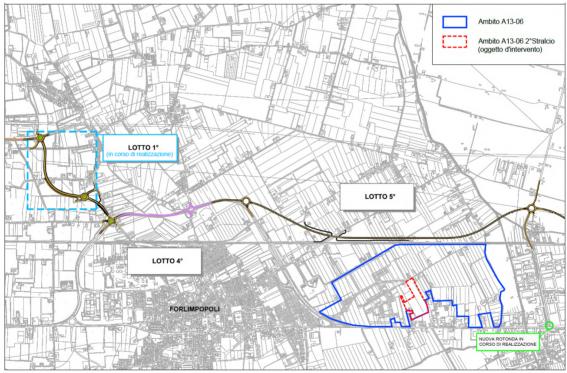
Tracciato strada di collegamento- tratto villa Selva-Forlimpopoli-Santa Croce
